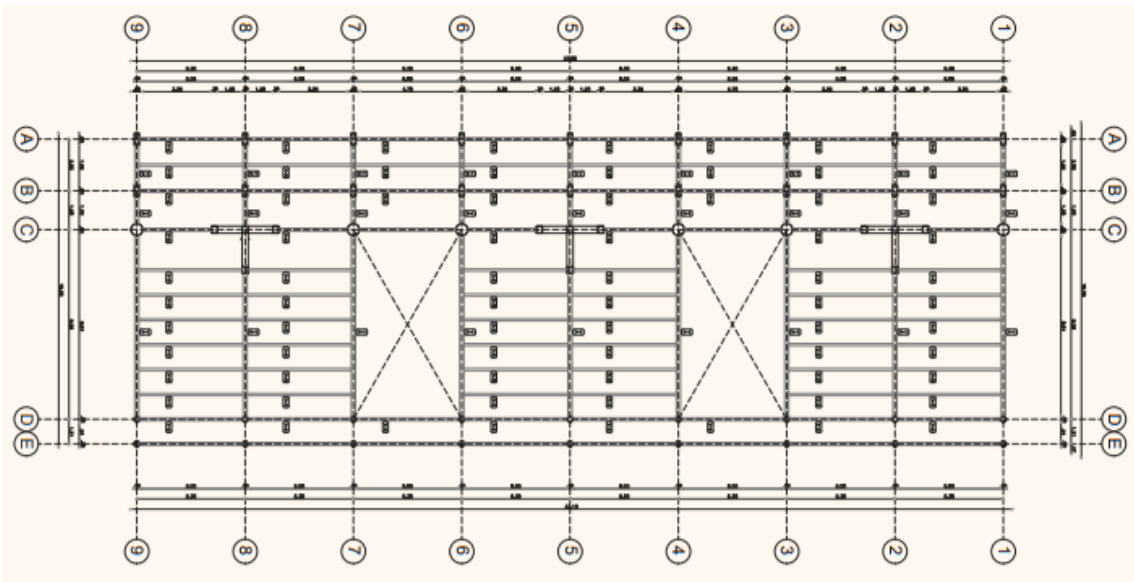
Tipos de columnas presentes en el objeto arquitectónico. Elaboración propia.
